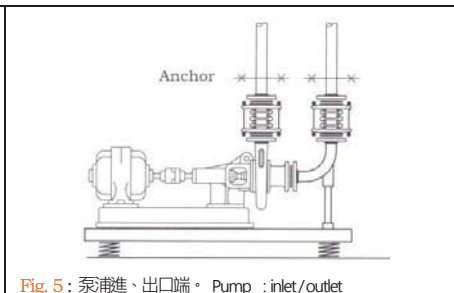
泵浦進、出口端。 Pump : inlet/outlet
